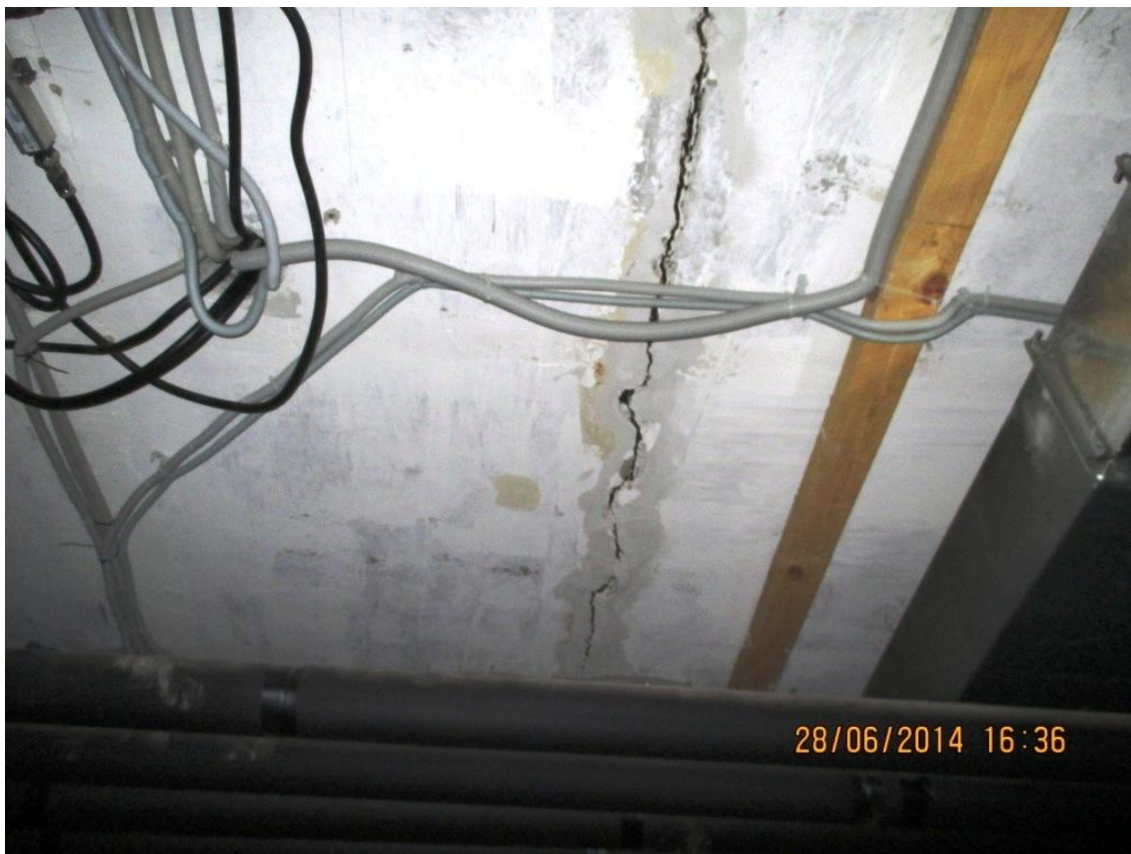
Деформационный шов плиты перекрытия над подземной автостоянкой.
